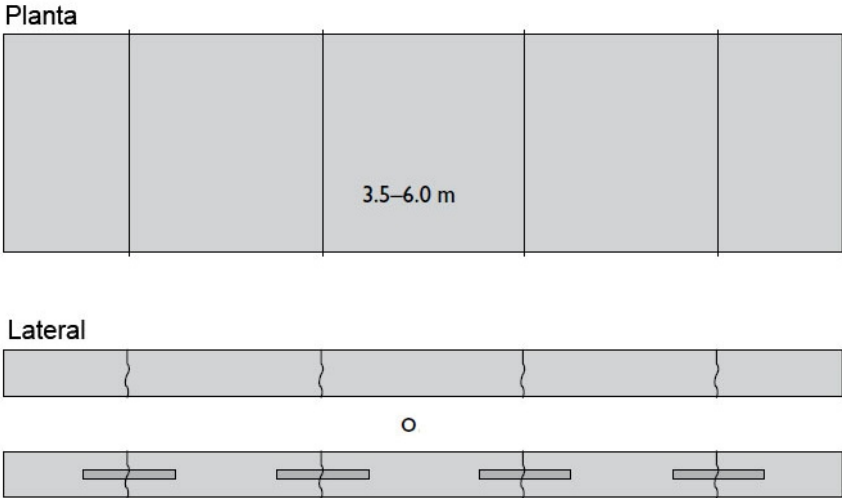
Esquema del pavimento de concreto con juntas sin refuerzo (Jointed plain concrete pavement (JPCP)). (Fuente: ACPA)
